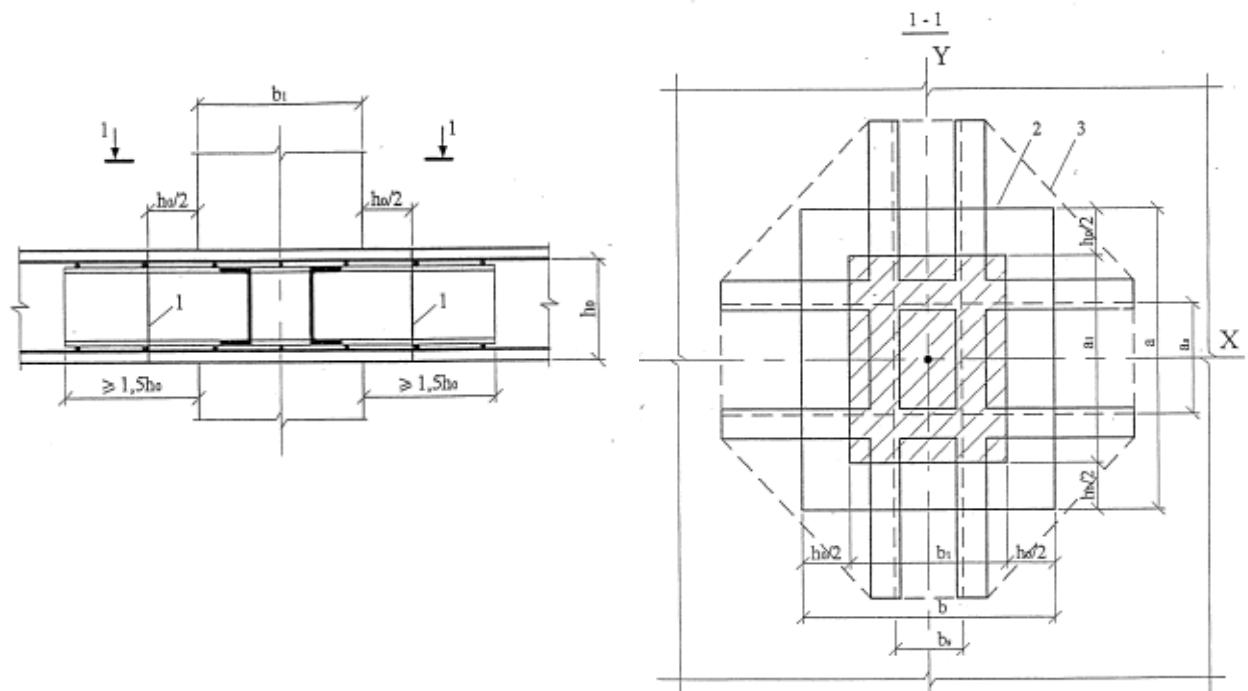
Схемы расчета железобетонных плит с жесткой поперечной арматурой на продавливание [5]: 1 - расчетное поперечное сечение, 2 - контур расчетного поперечного сечения плиты, 3 - контур поперечного сечения без учета в расчете стальных элементов
